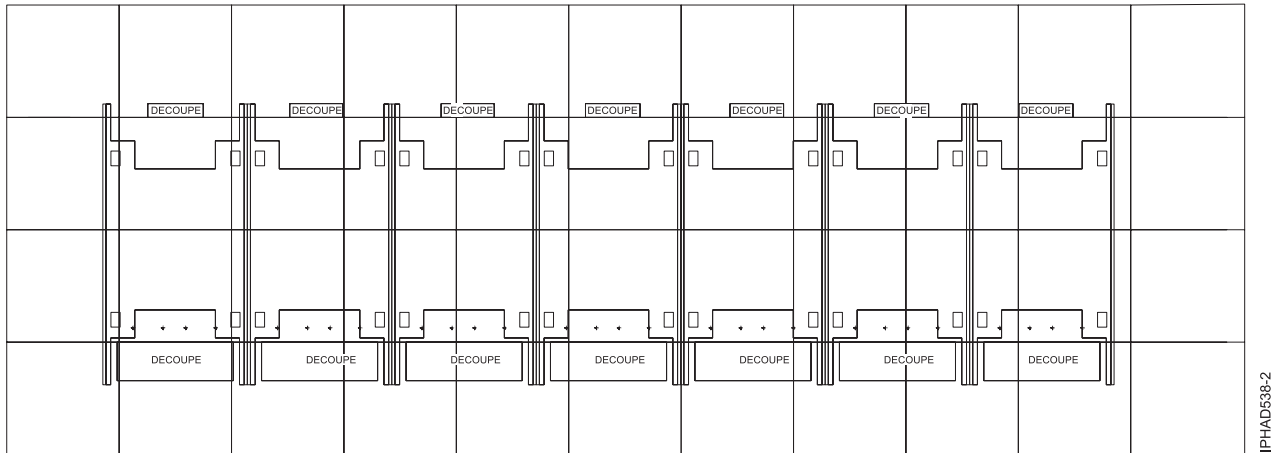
Découpe de dalle de plancher de 600 mm avec plusieurs cadres (premier cadre sur le bord de la dalle de plancher)
